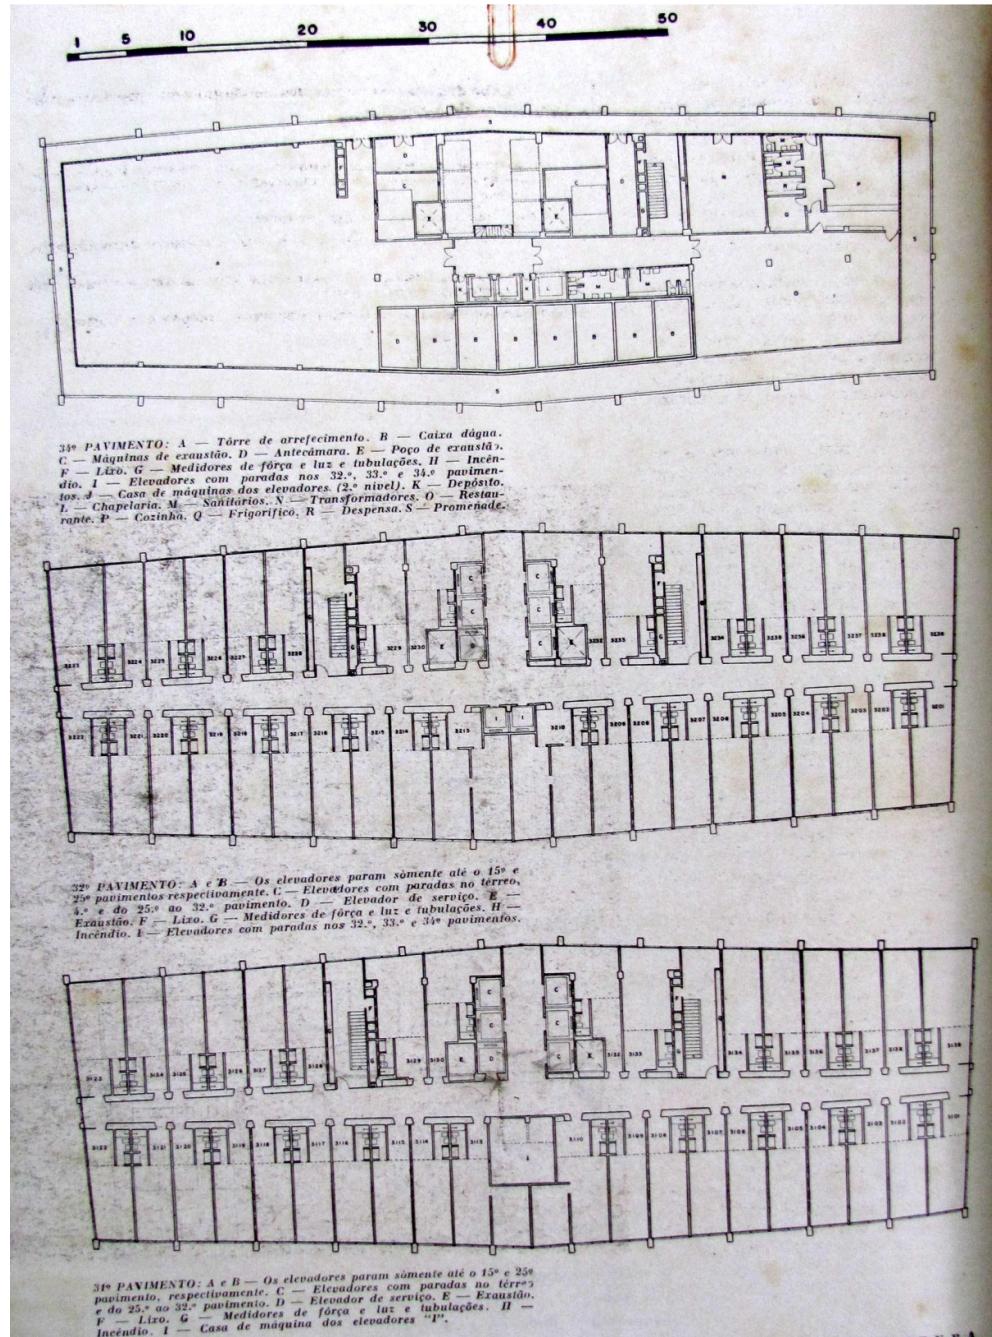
H – Variações de plantas baixas de pavimentos tipo da torre e planta bx. do último andar (desenhos com deformações devido a limitações de reprodução)
